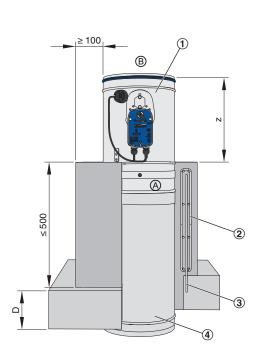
Massivdecke, Nasseinbau in Betonsockel
